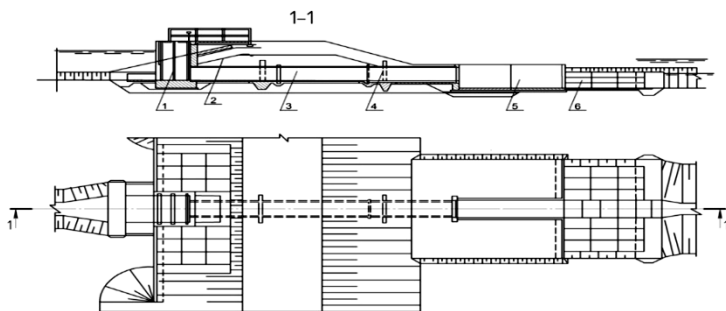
Водоспуск (ОАО «Полесьгипроводхоз»): 1 – башня для размещения решеток и шандоров; 2 – экран из полиэтиленовой пленки; 3 – труба; 4 – железобетонная диафрагма; 5 – рыбоуловитель; 6 – канал
